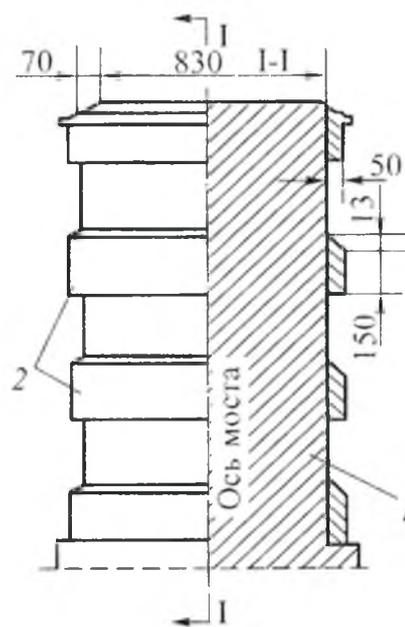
Усиление опоры железобетонными поясами: 1 — кладка опоры; 2 — железобетонные пояса
